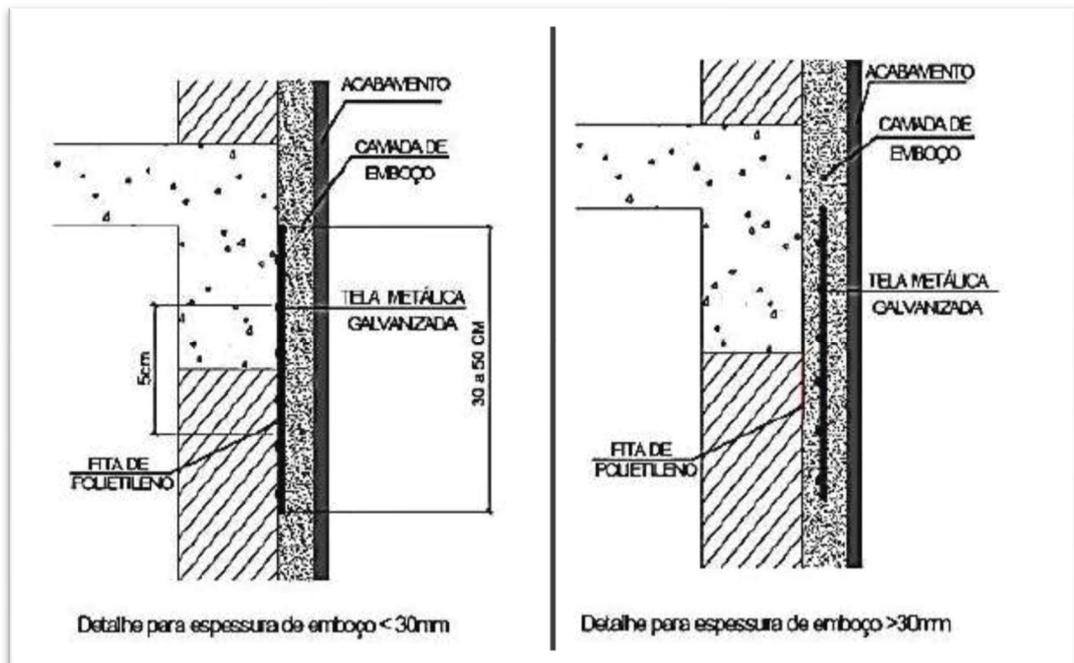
Posicionamento das telas metálica na camada de recuperação.
